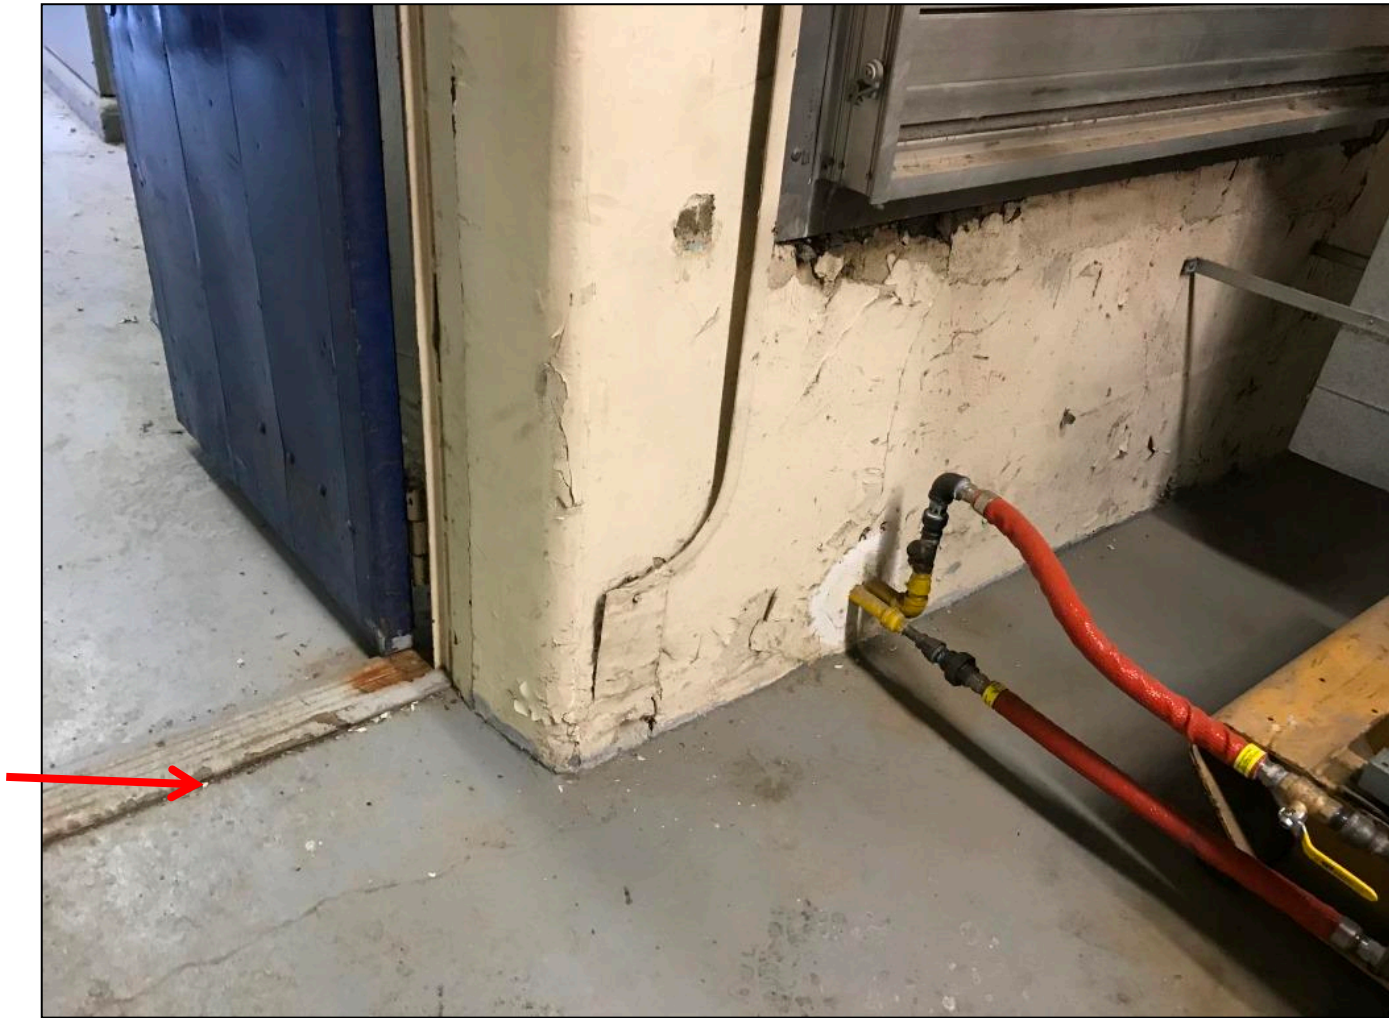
Rez-de-chaussée, Salle 110 – Peinture beige (contenant du plomb)
